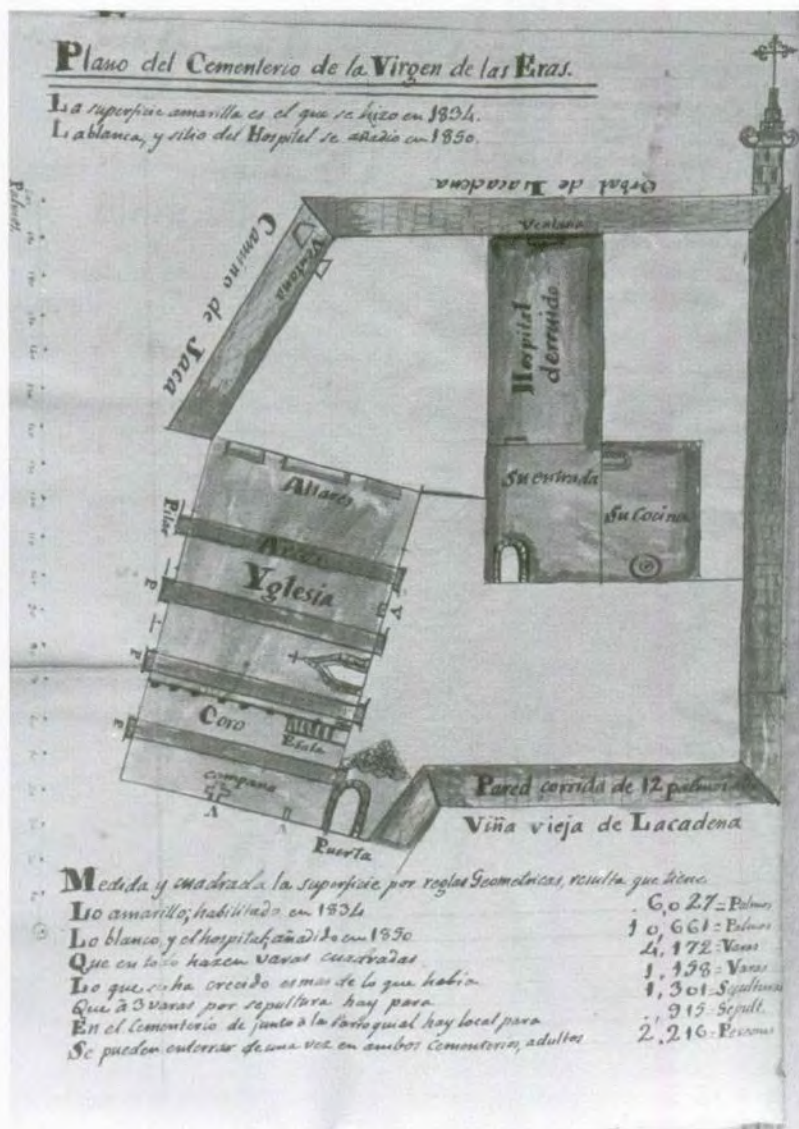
Plano del cementerio dibujado por Melchor Avellana en 1850.
